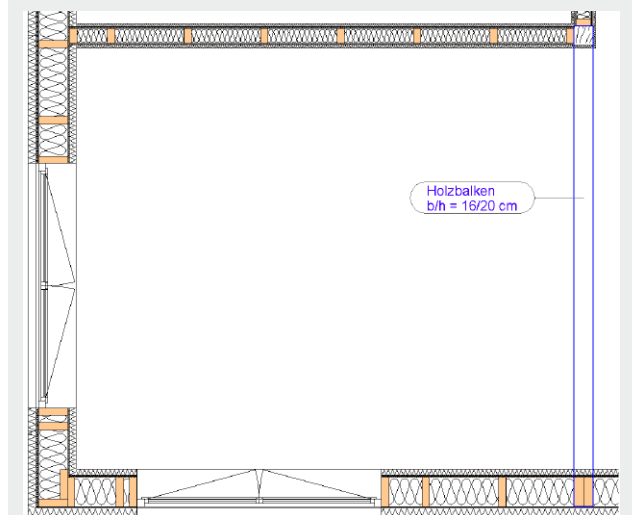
1. OG (Ausschnitt) mit Darstellung Holzbalken
